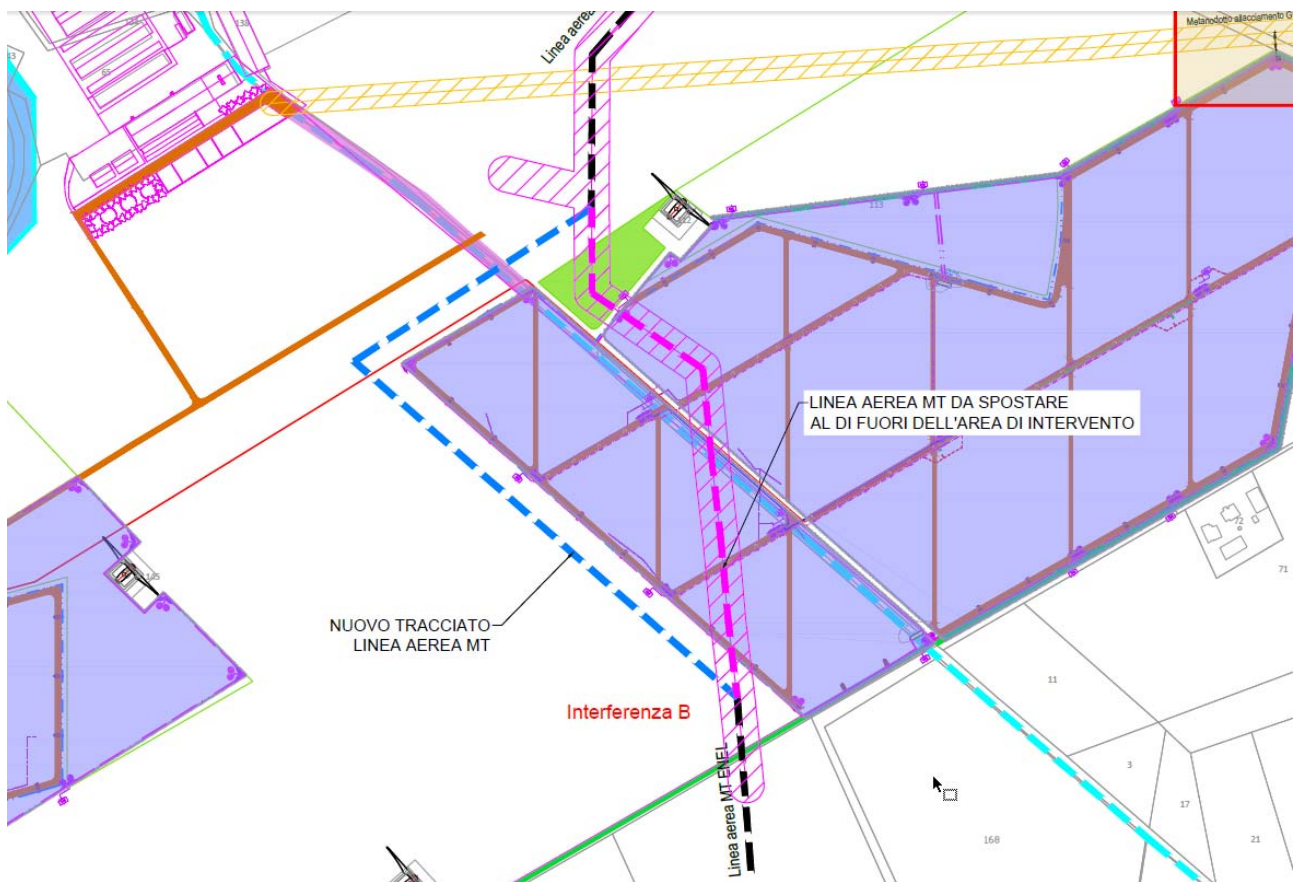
d. Stralcio del progetto con evidenza della linea aerea MT esistente
